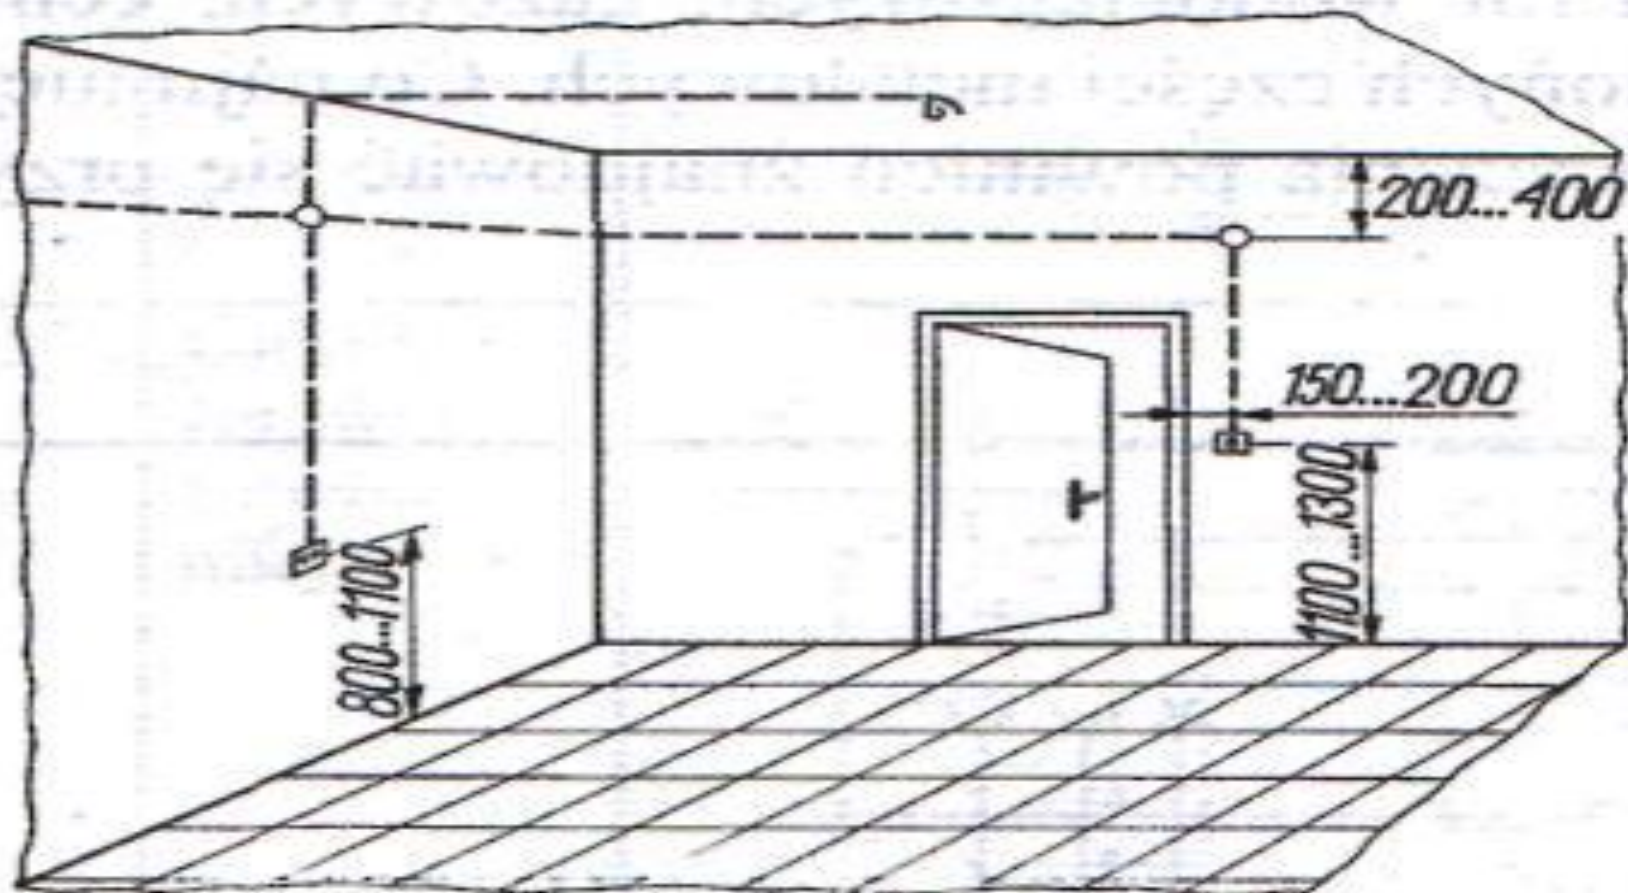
Schemat instalacji elektrycznej przedstawionej na planie rys 5.10
